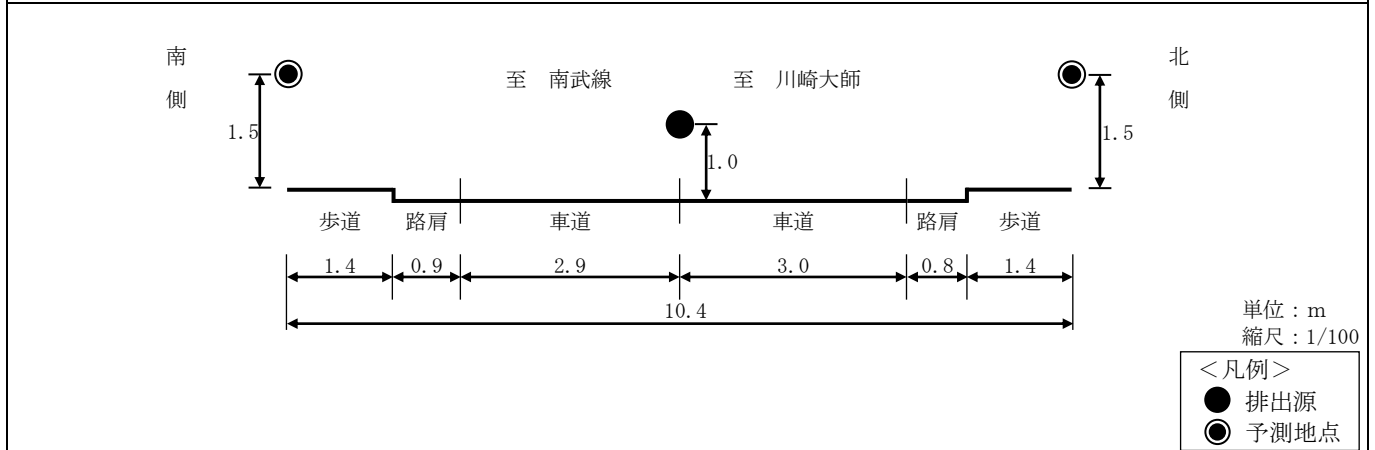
(3) 道路横断面構成及び排出源の位置
